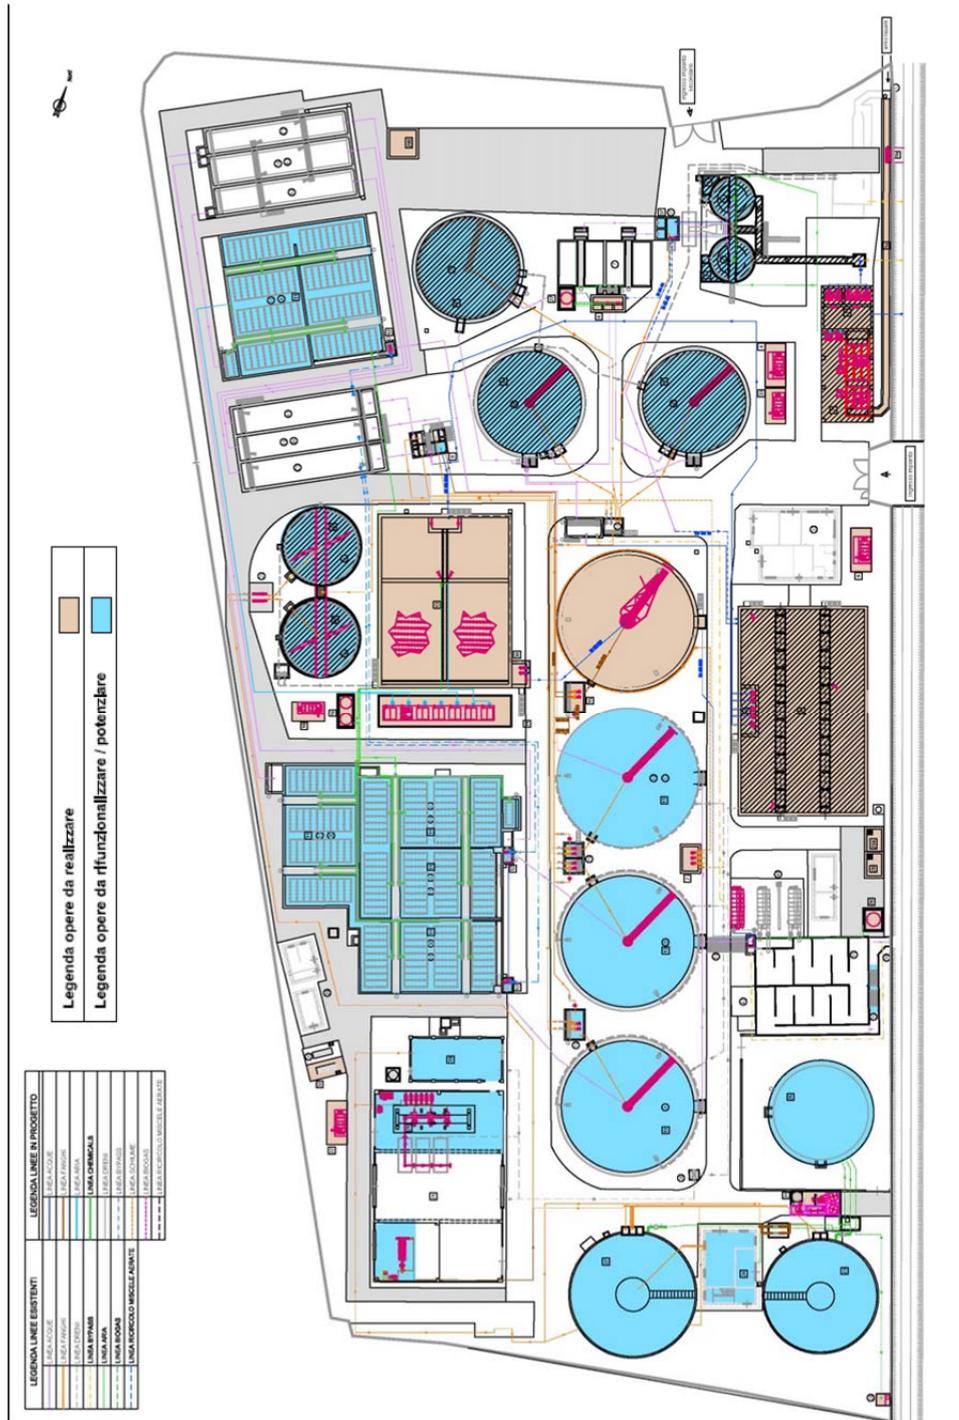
PLANIMETRIA DELLO STATO DI PROGETTO
